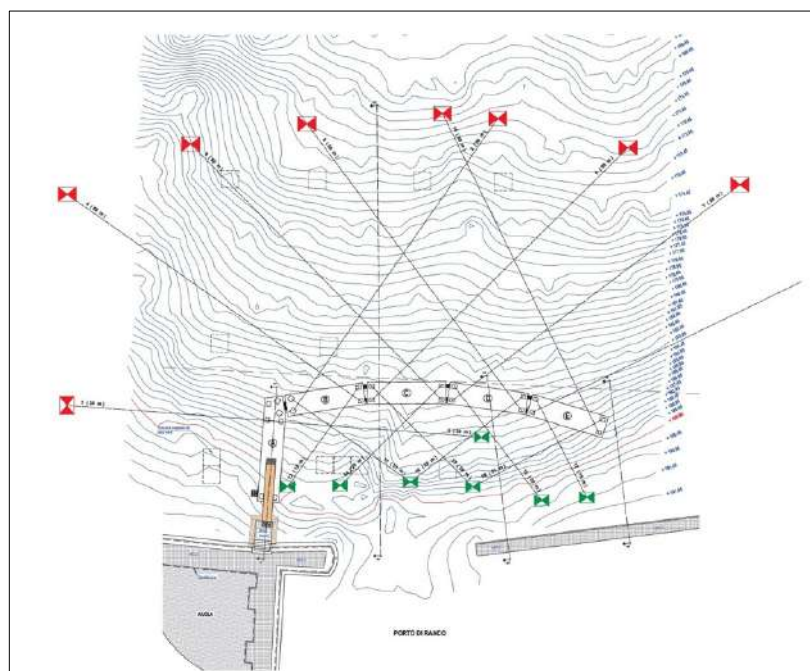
Ranco – Planimetria e sezione della diga di protezione posta all’imboccatura del preesistente porto
